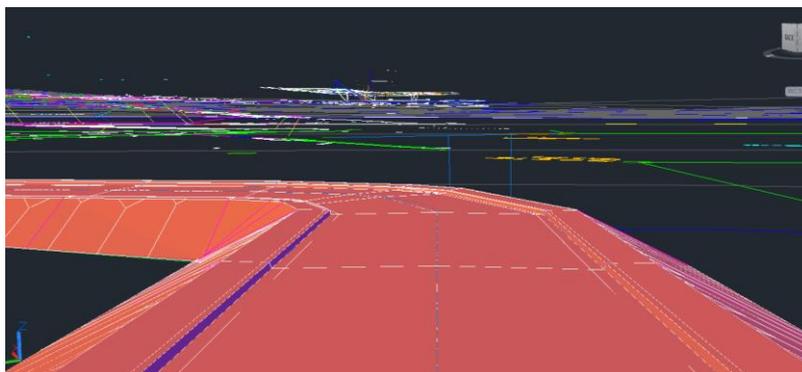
Vista tridimensional de Inicio de la Vía Alternativa.
